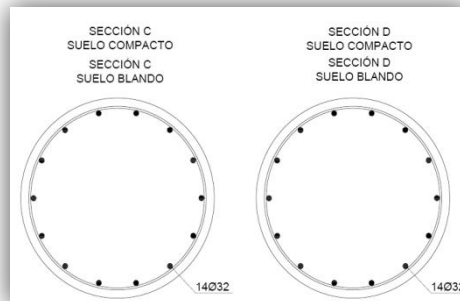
Detalle armadura longitudinal Pilote, sección C y D
